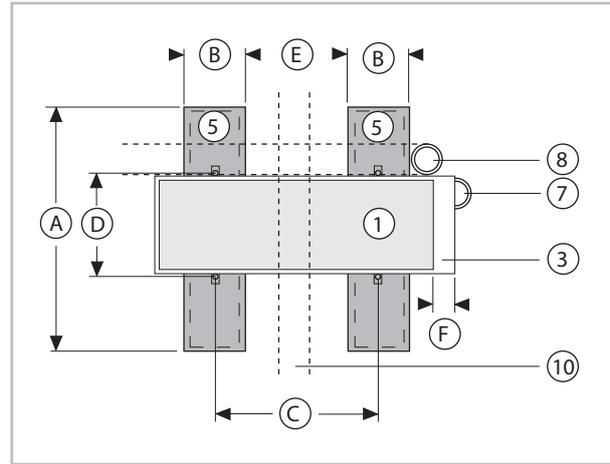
Dimensions des semelles filantes (vue du dessus)
